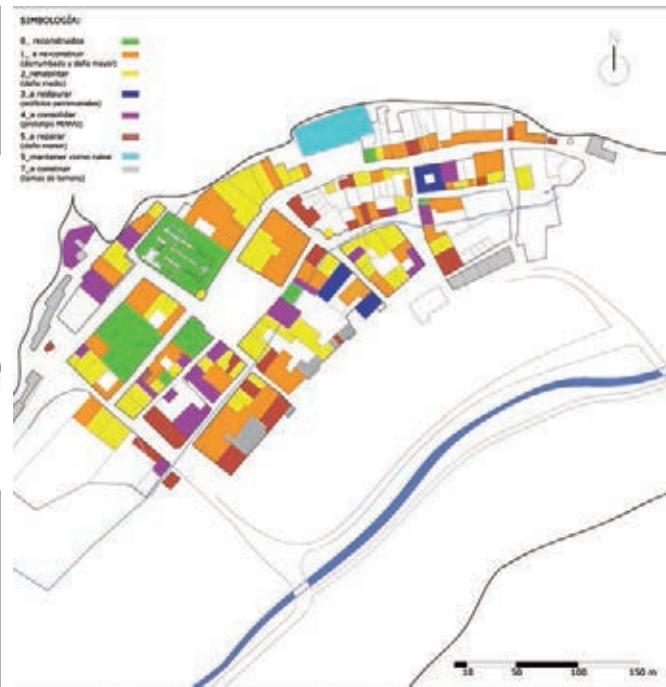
Plano con las distintas acciones de intervención propuestas dentro del Plan de re-construcción para San Lorenzo de Tarapacá. Elaboración propia en base a material de Proyecto Tarapacá.
